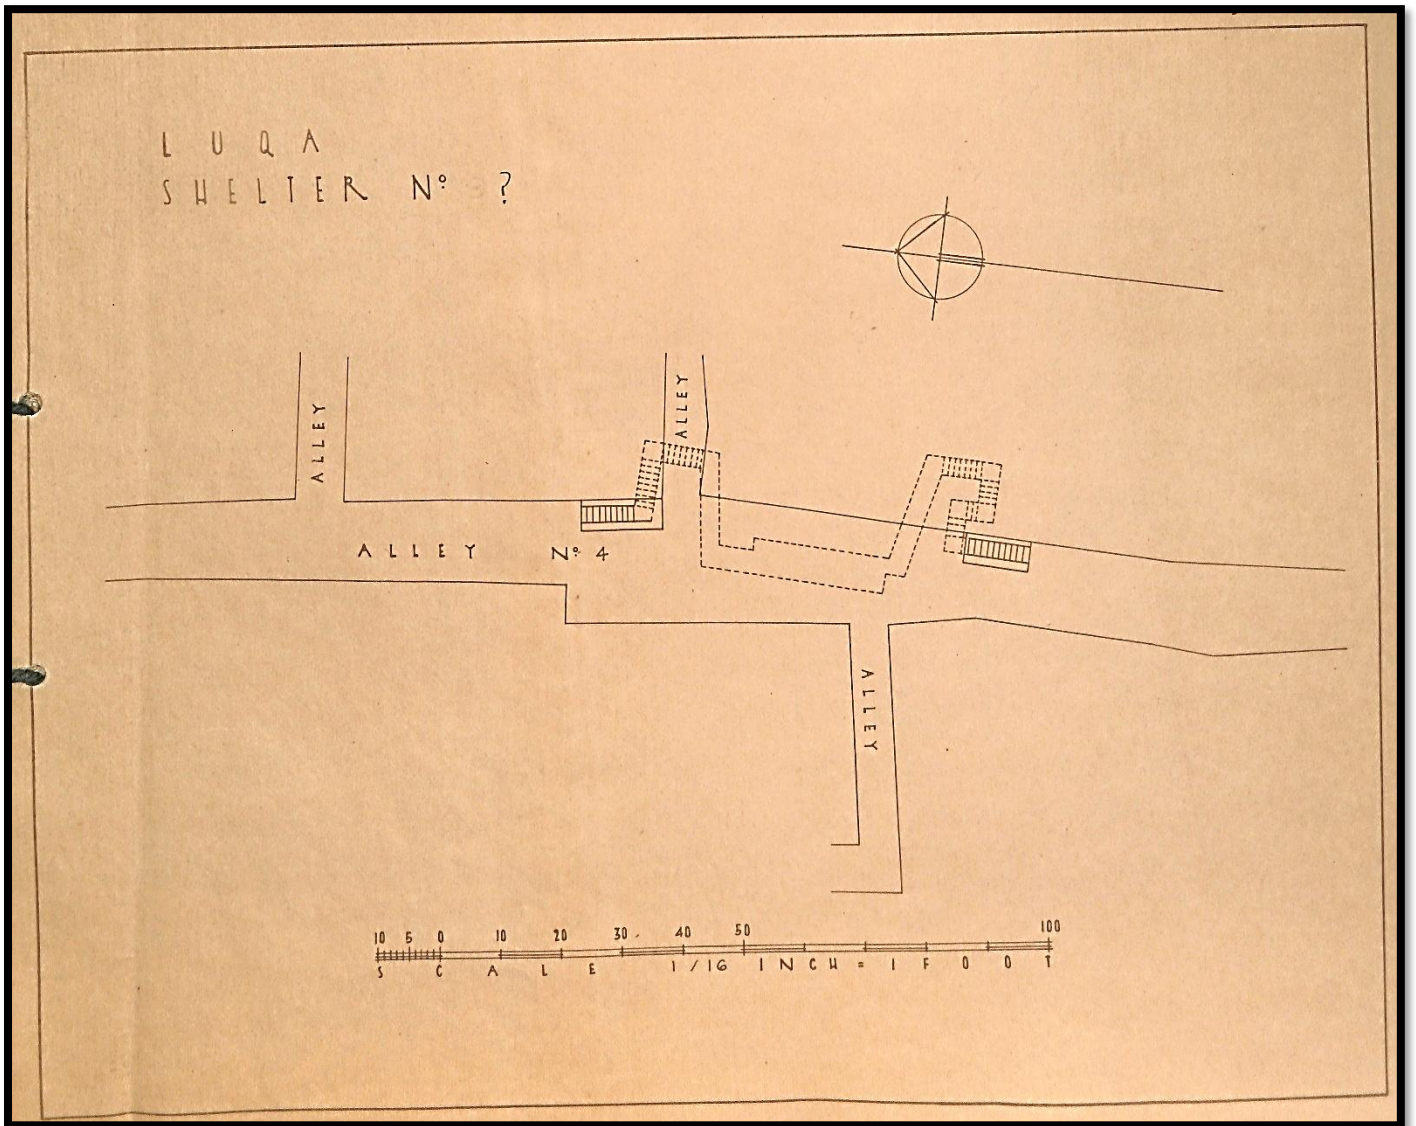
Planta do Abrigo nº3 (?) "Alley nº4"
